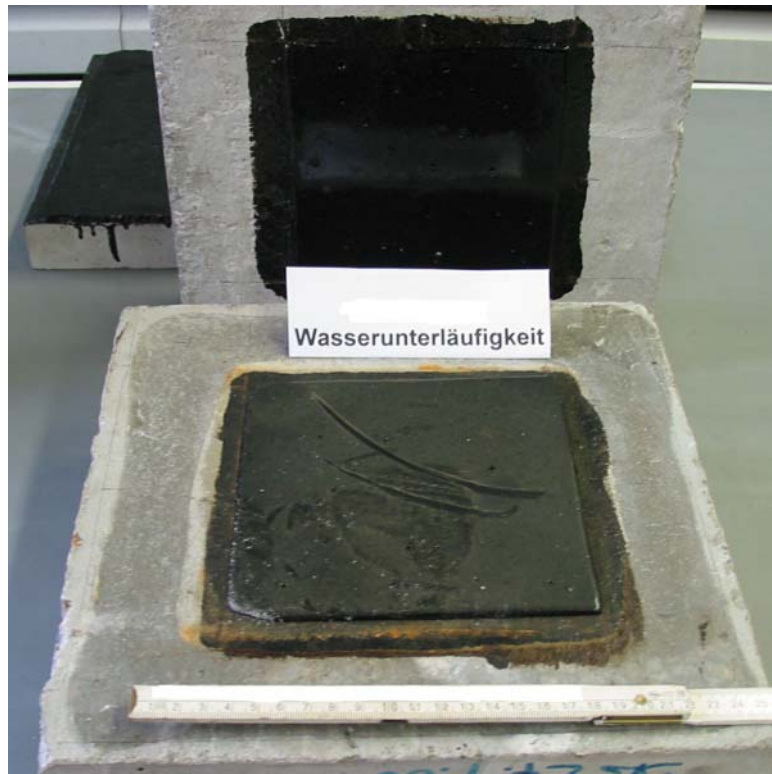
Beschichtete Betonplatte vor (oben) und nach (unten) Belastung mit Wasserdruck für 8 Tage.
